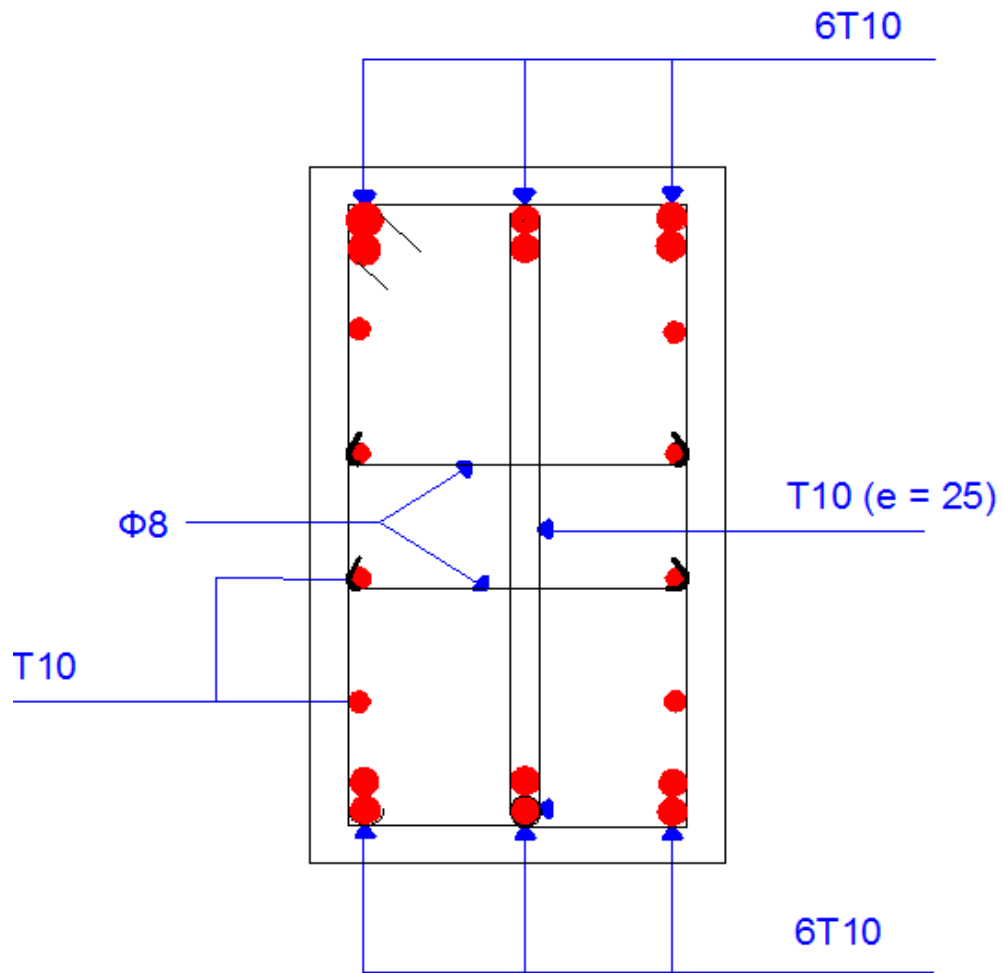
Plan de ferrailage de l'entretoise d'about
